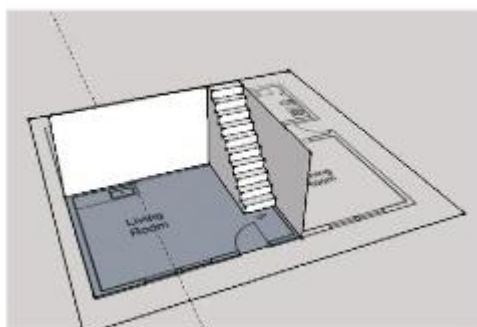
Ubah Bidang Pandang Menjadi 60° Untuk Tampilan Ruang Yang Lebih Luas
